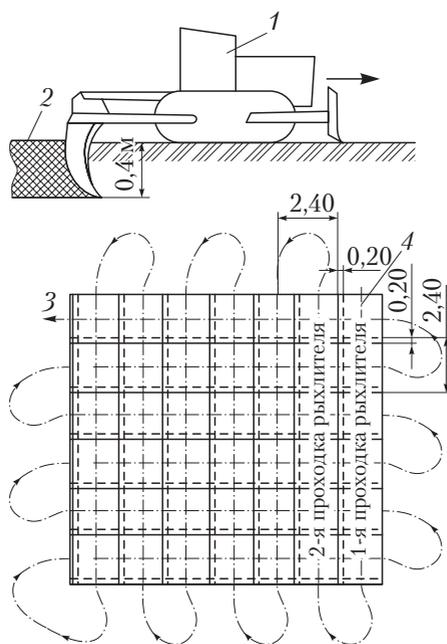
Схема рыхления грунта для предохранения его от промерзания: 1 — рыхлитель; 2 — вспаханный грунт; 3 — схема продольной проходки рыхлителя; 4 — схема поперечной проходки рыхлителя
